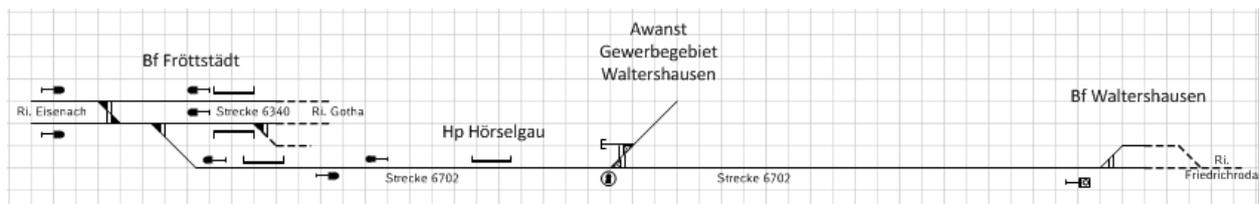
Lageplanskizze Awanst Gewerbegebiet Waltershausen nach Infrastrukturvariante 1
